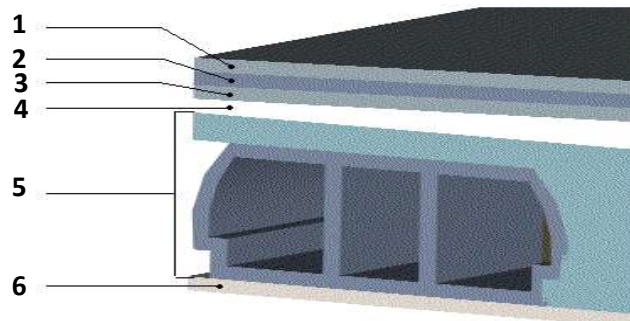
Coupe transversale d'un plancher terrasse inaccessible
